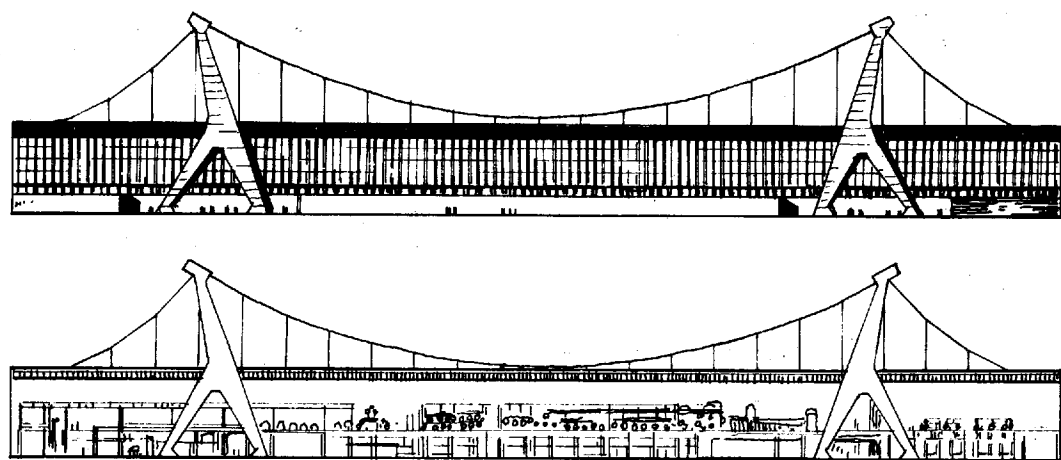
厂房侧立面和纵剖面，生产机器安装在厂房内，厂房结构不受屋架结构变化的影响。钢筋混凝土塔架支撑着整个厂房。围护结构为磨砂玻璃，用垂直钢筋混凝土肋加筋，塔架和钢缆支撑整个屋顶结构，明显地与不承重外墙隔离。
